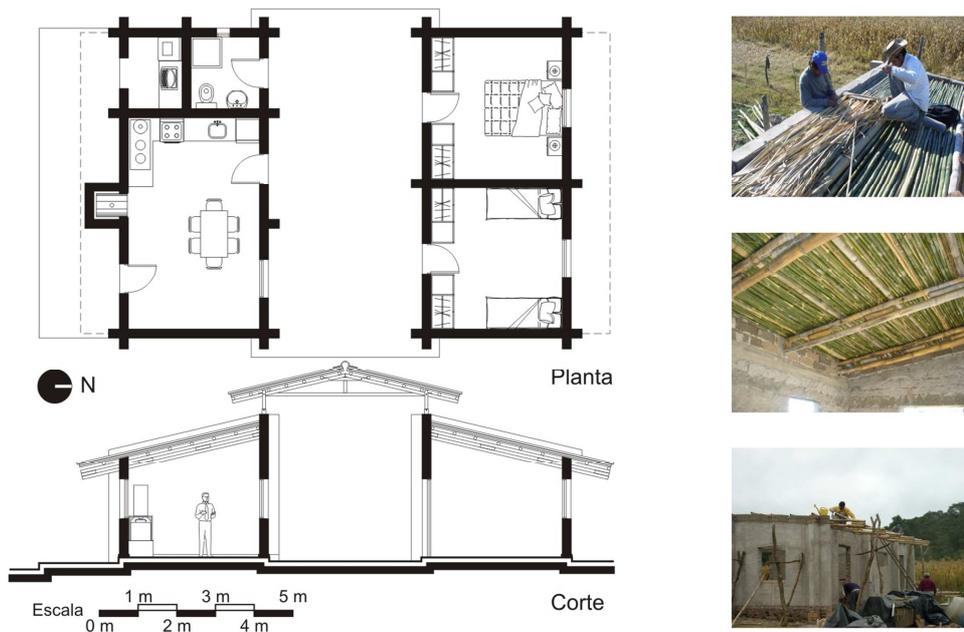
A la izquierda: Planimetría general de la vivienda diseñada. A la derecha: Construcción de un prototipo piloto en el área estudiada. Las imágenes muestran la construcción del techo y cielorraso.
